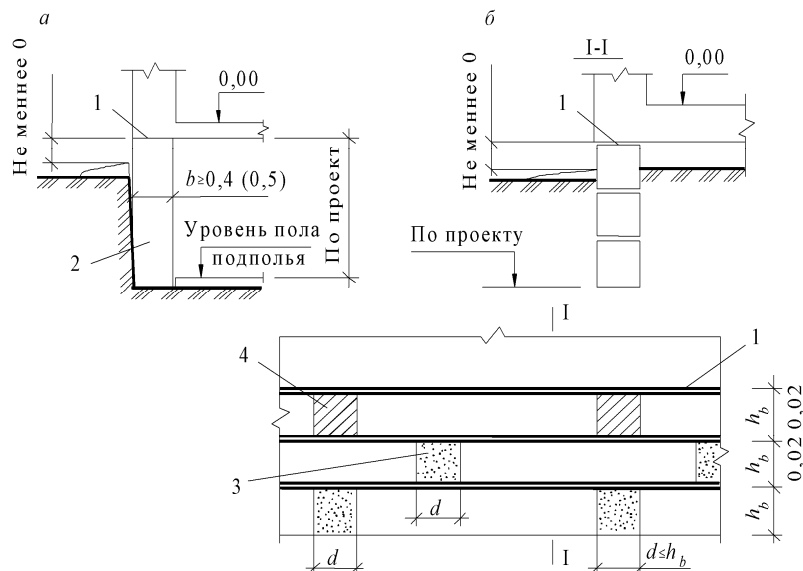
Фундаменты без уширения к подошве для одно- и двухэтажных зданий:
